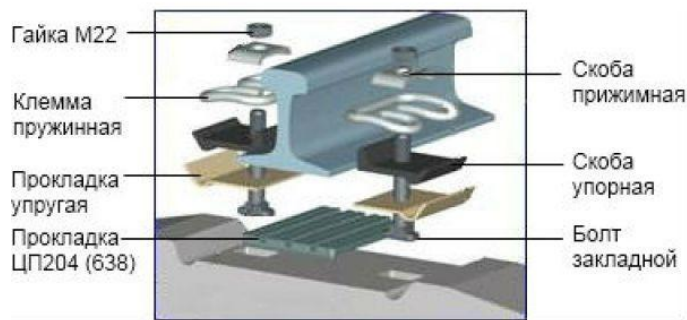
Бесподкладочное крепление ЖБР-65
